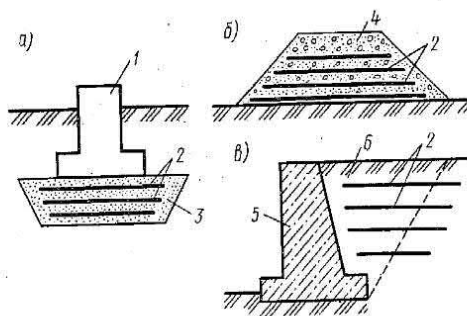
Армирование грунта в искусственном основании фундамента (а), при устройстве насыпи (б), при возведении обратных засышек (в):
